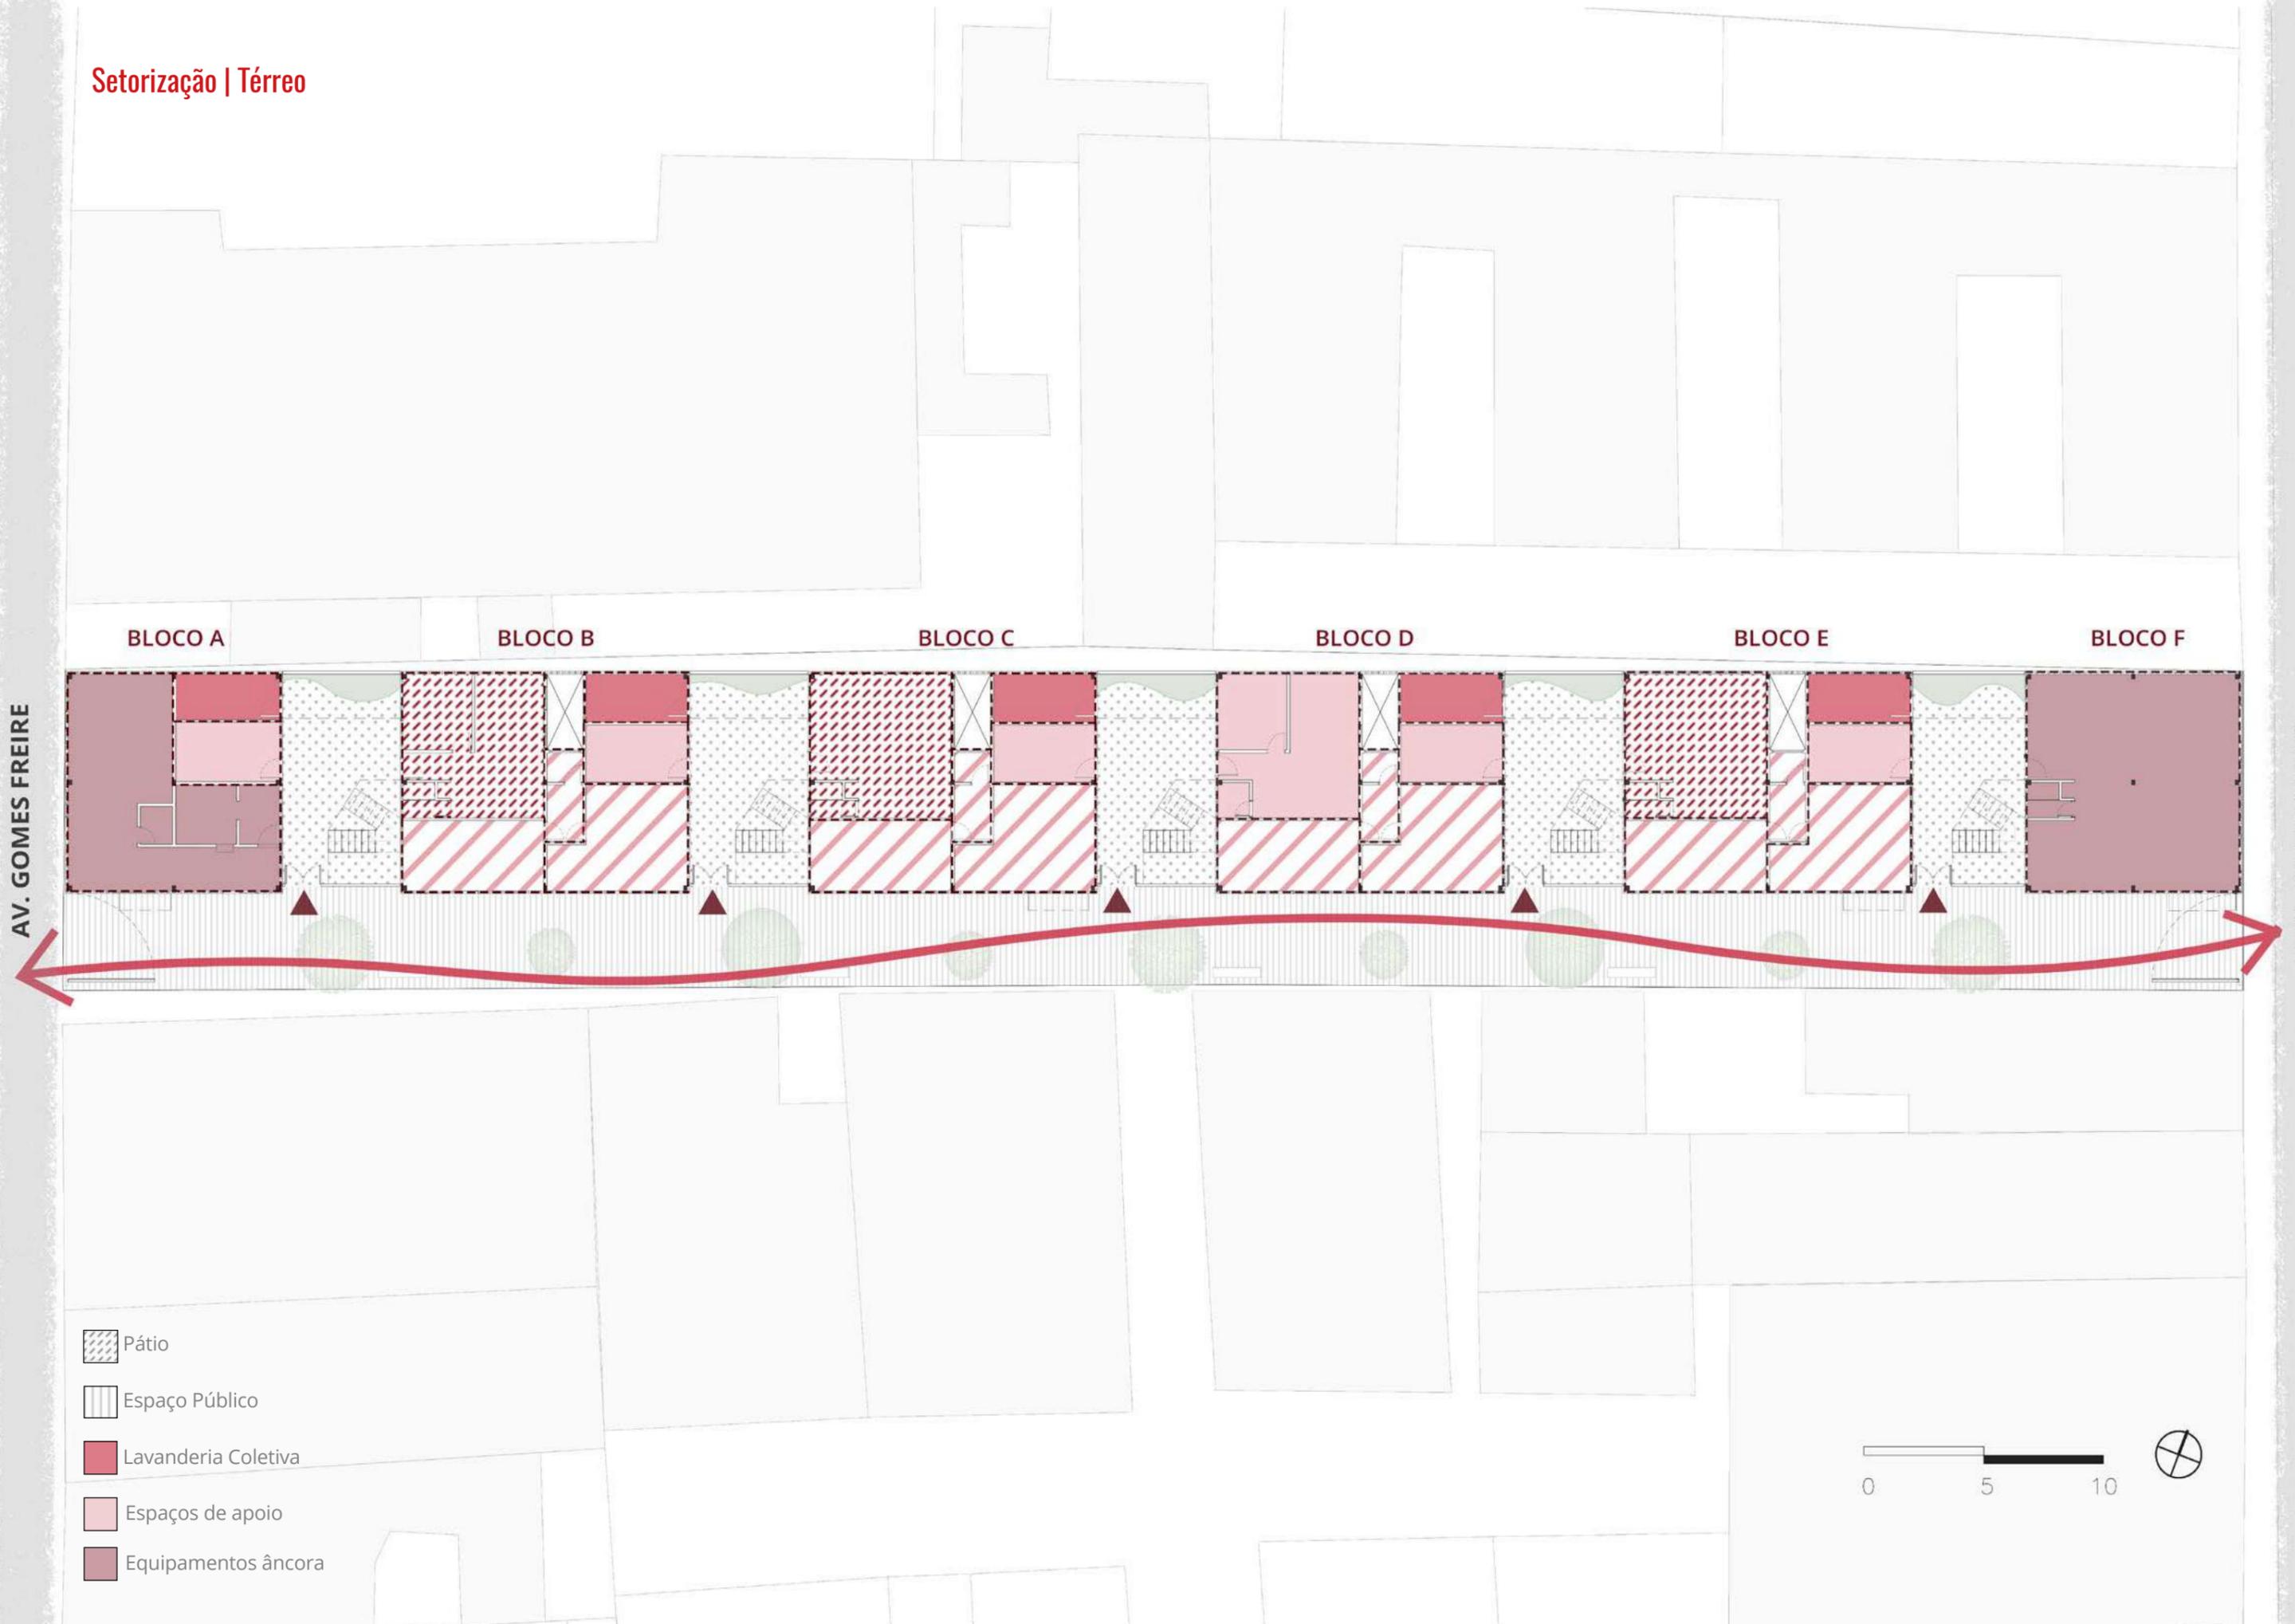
Planta de Implantação | Fonte: Elaborado pela autora
